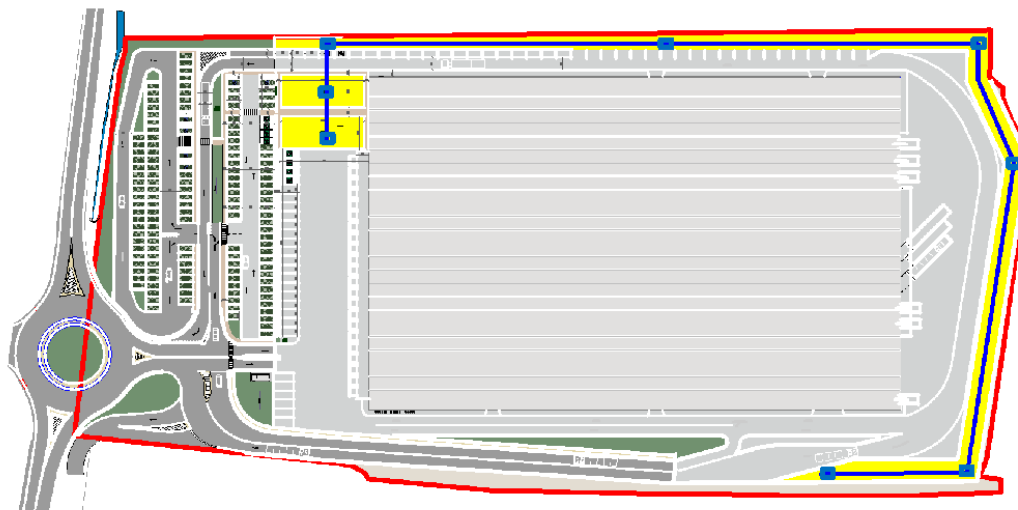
Planimetria con indicazione delle opere idrauliche di laminazione/smaltimento
